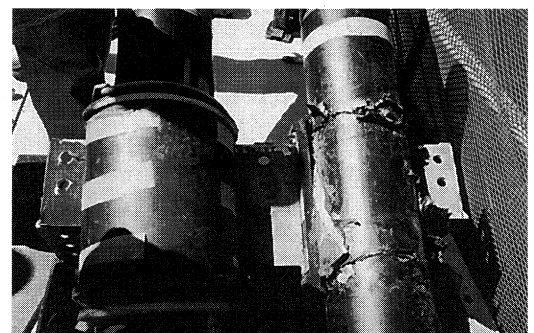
PE管の損傷状況（櫃石島橋東ケーブルNO.22）
